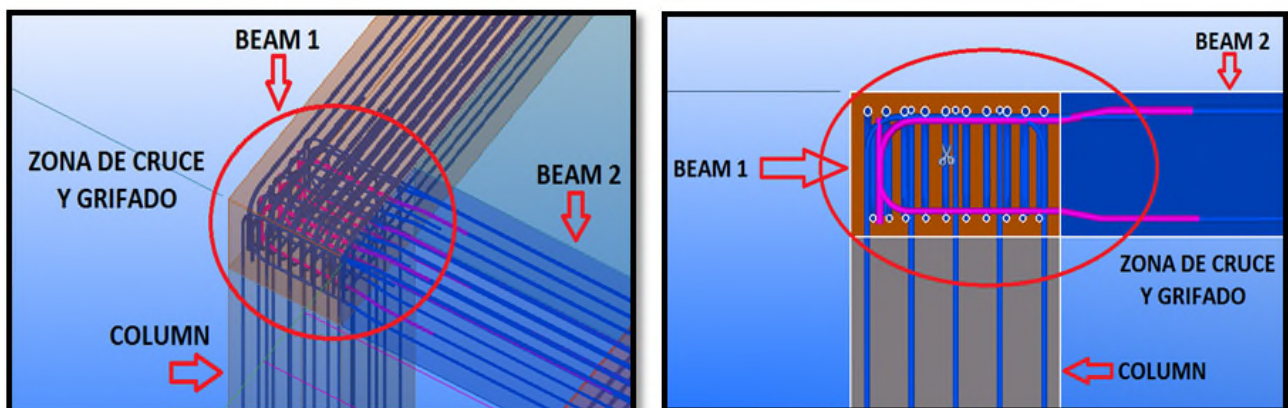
Disposición de armadura en encuentro cabeza de pilar/vigas de losa
